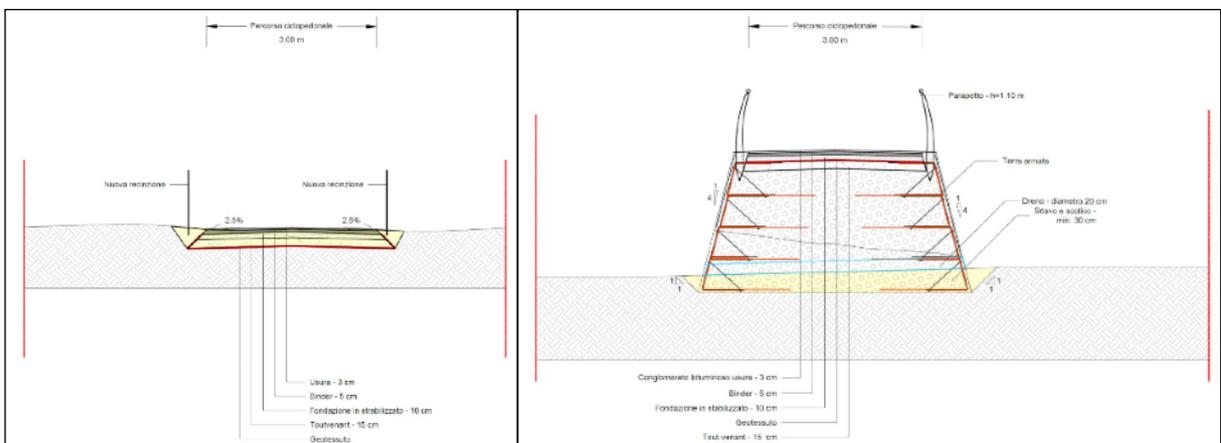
Sezione C30 – Nuova ciclovie a raso - Sezione E8 – Nuova ciclovie su terre armate
